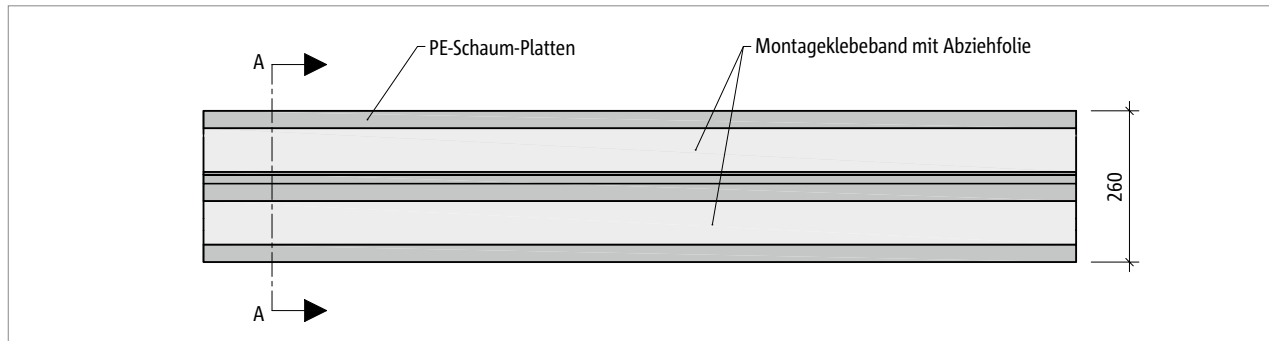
Schöck Tronsole® Typ F: Ansicht
